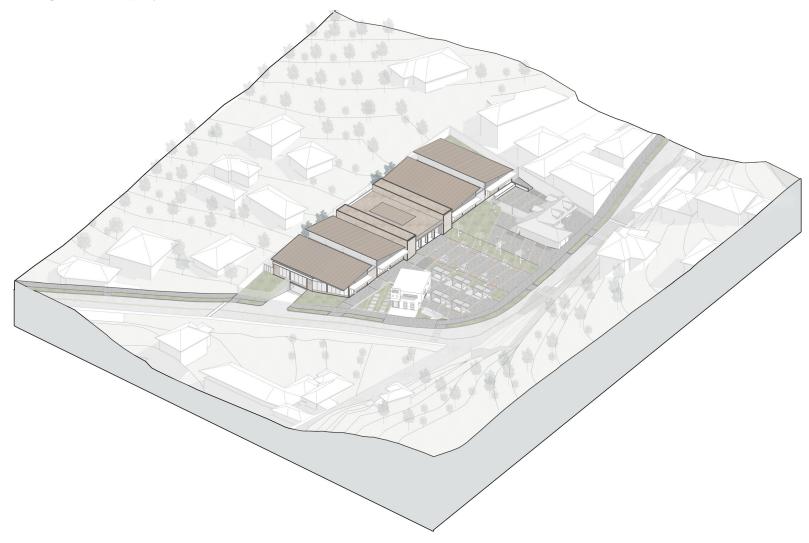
Axonometría general del proyecto. Fuente. Autores, 2024
